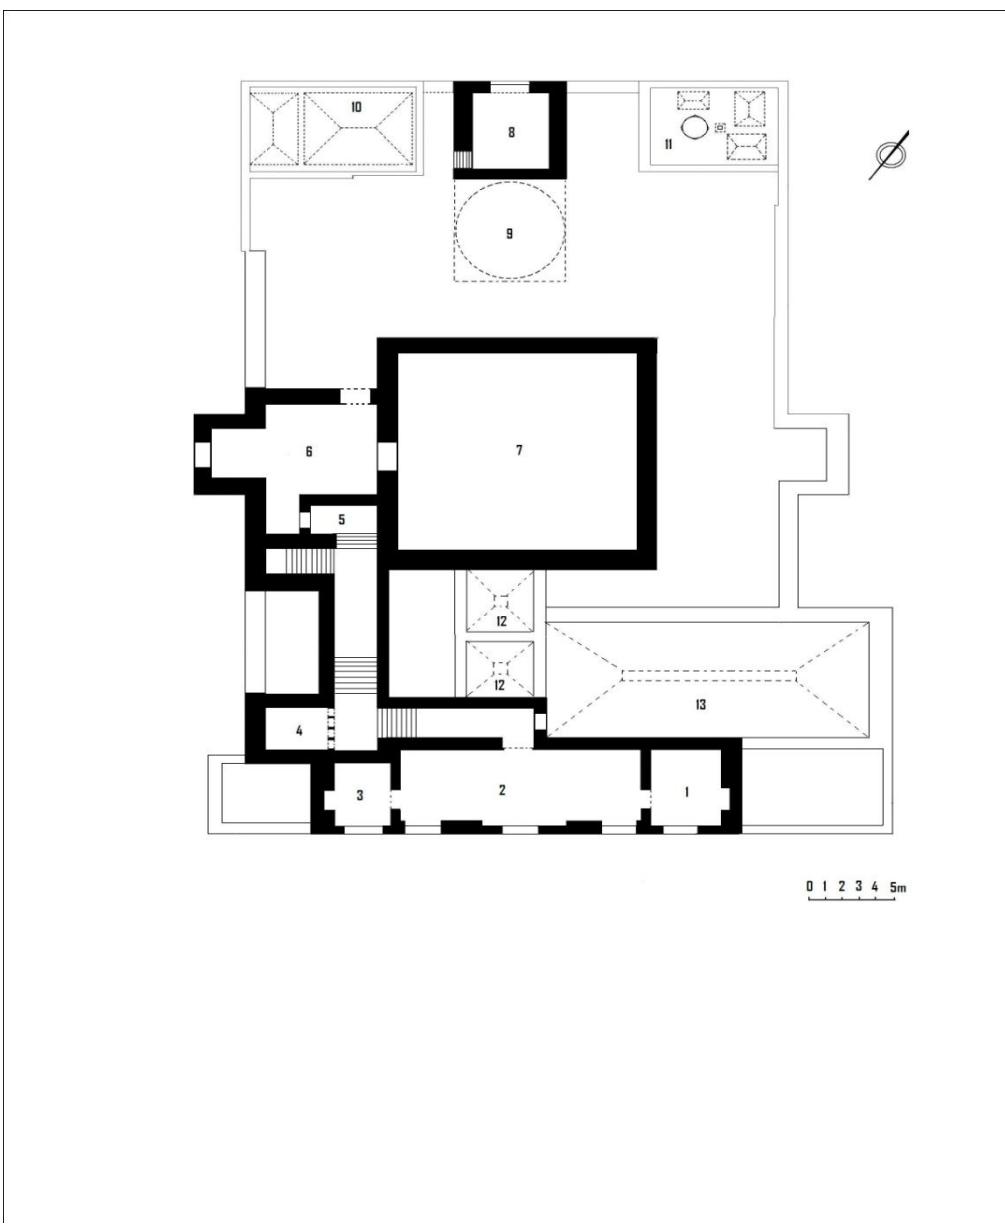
Borj Kobbet-En-Nhas.* Plan du rez-de-chaussée.
